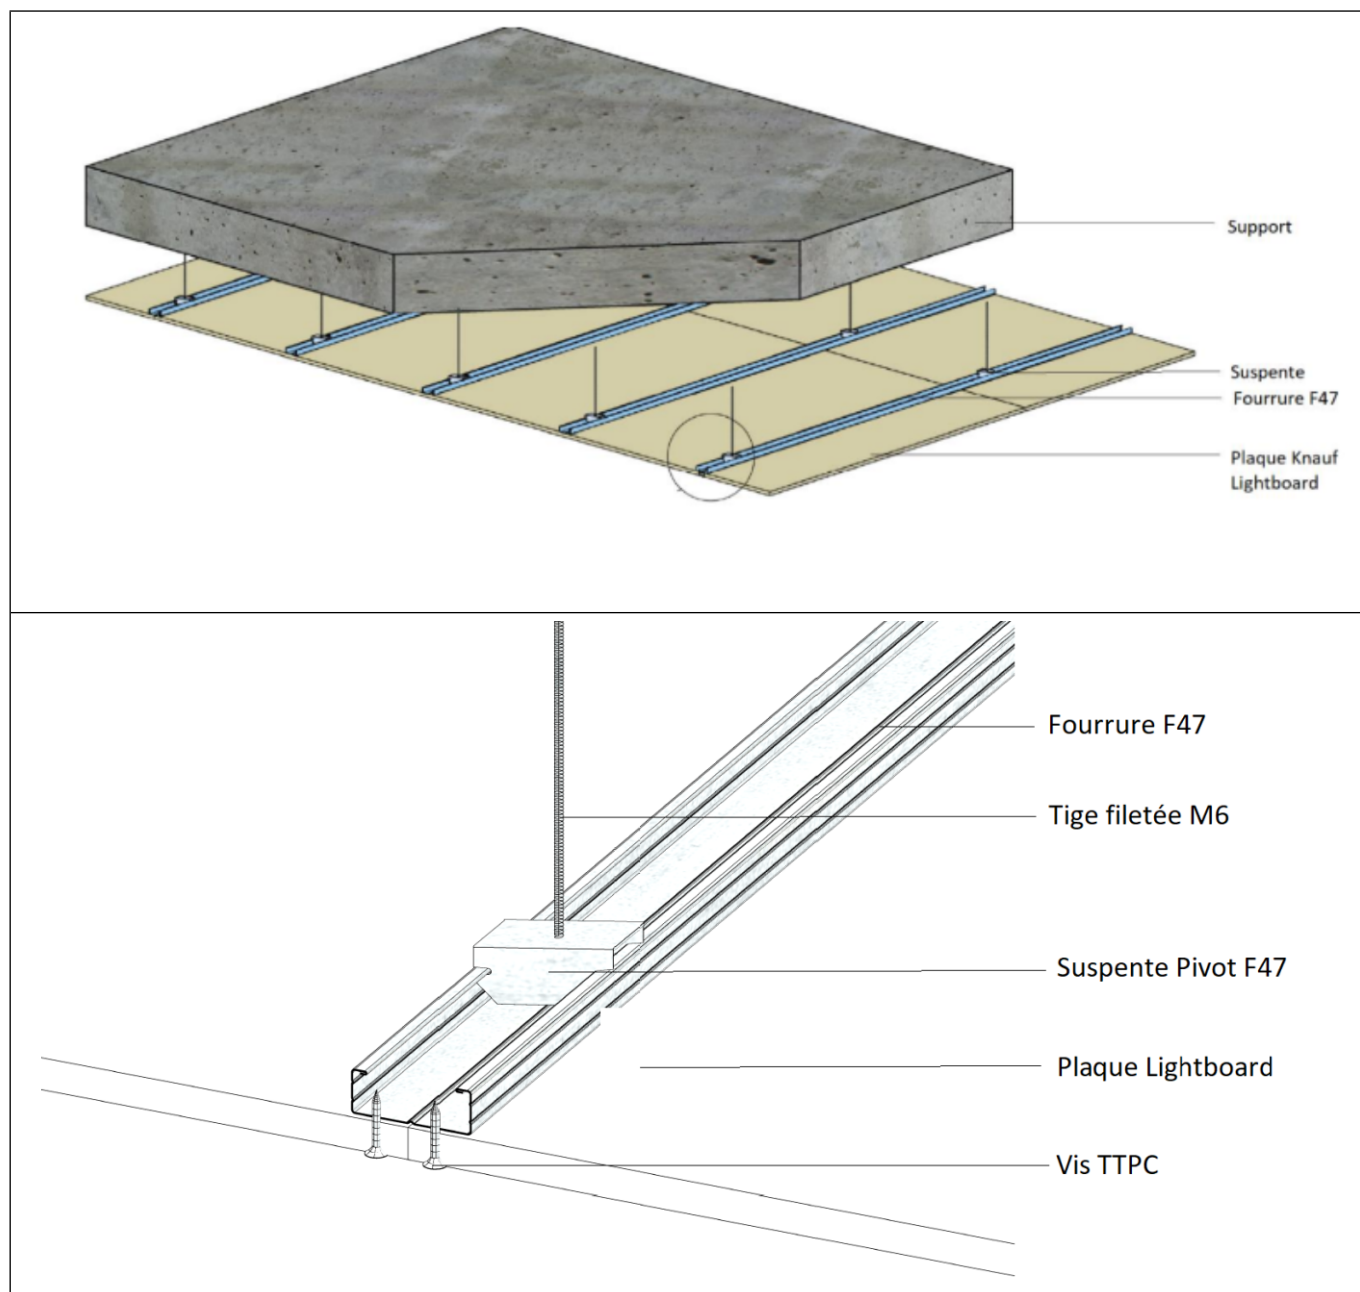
Plafond Knauf Lightboard - Exemple avec suspente pivot
